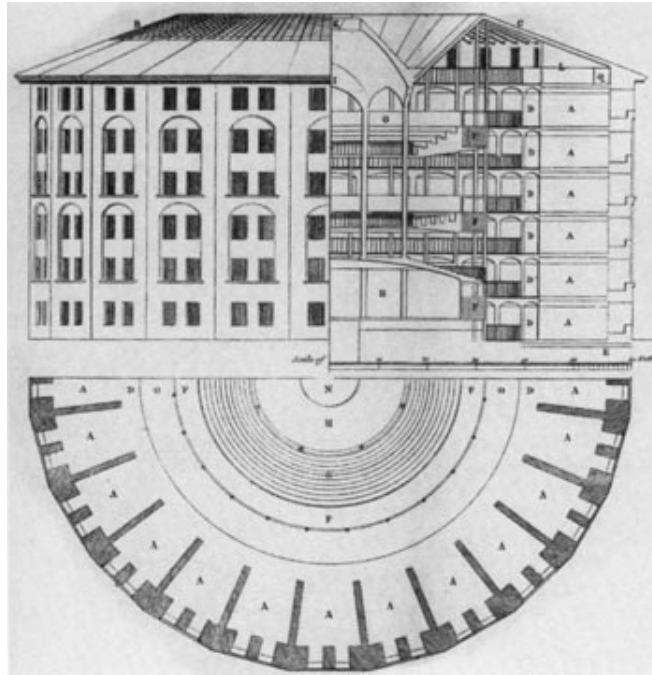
Planta e corte/alçado do panóptico de Bentham
